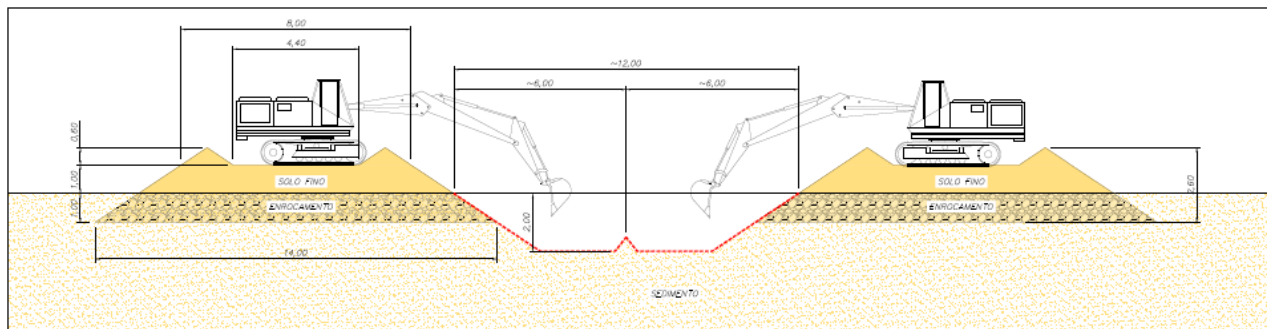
Seção típica dos aterros de conquista – Projeto executivo
